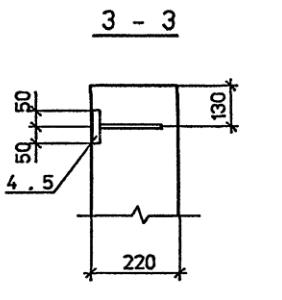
Для крепления связей к средним Фермам при ветровых нагрузках
